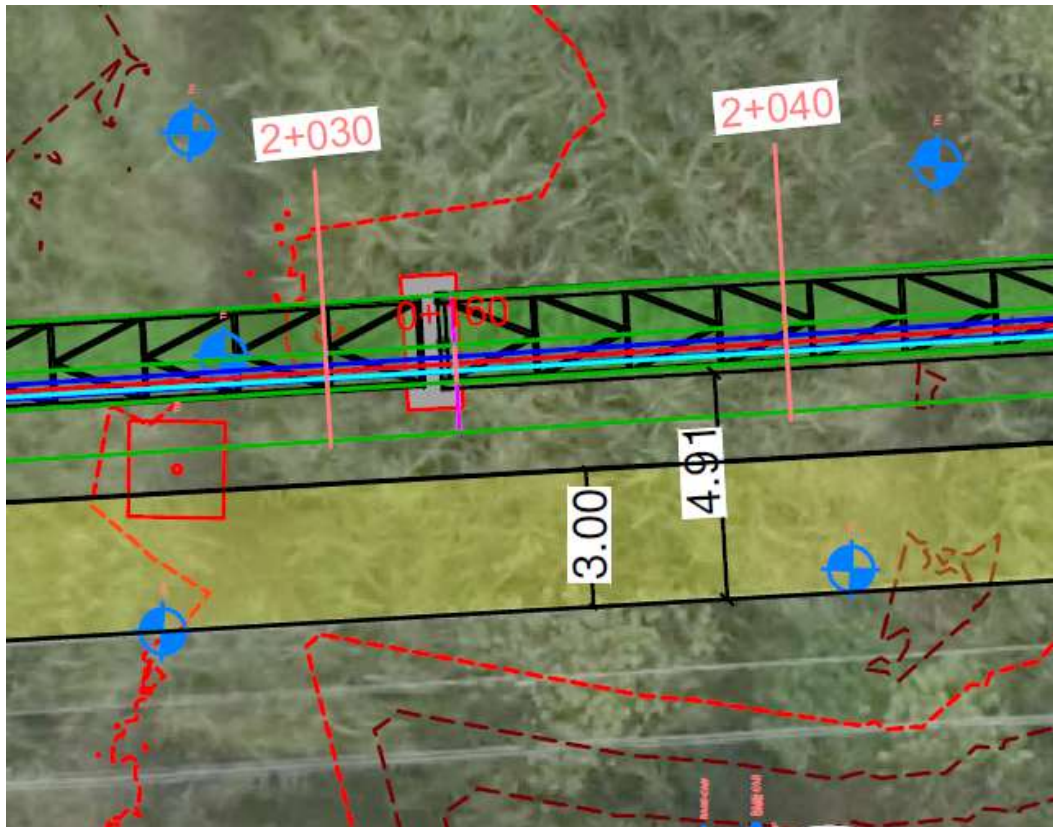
Distancia entre tendido eléctrico y cercha. En el plano acotado presentado en la sección de anexos, la distancia es de 4.91 m del tendido eléctrico a la cercha; la franja de 3m es para trabajo seguro como referencia de la norma OSHA.
